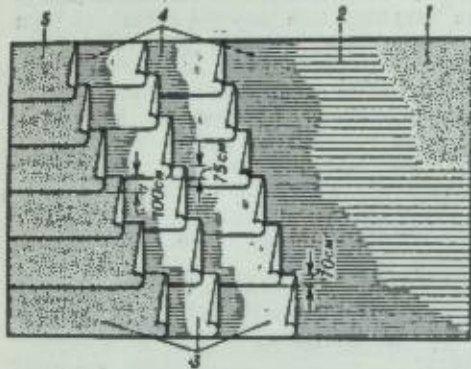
Схема расположения полотен гидроизоляционного ковра трехслойной рудонной кровли: 1 — основание под рудонный ковер (стяжка); 2 — огрунтовка холодной мастикой; 3 — трехслойная кровля; 4 — прилегающая мастика; 5 — защитный слой.
